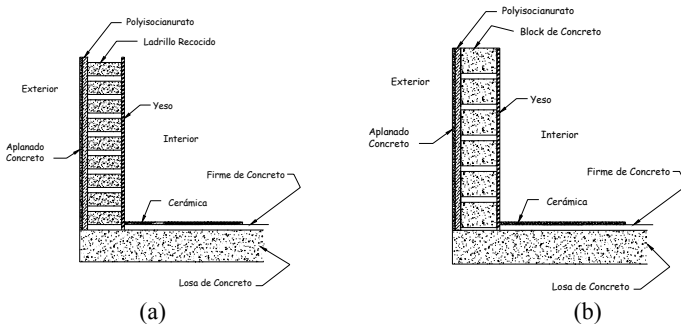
Sección Transversal de Muros, (a) Ladrillo, (b) Bloque de Concreto.
